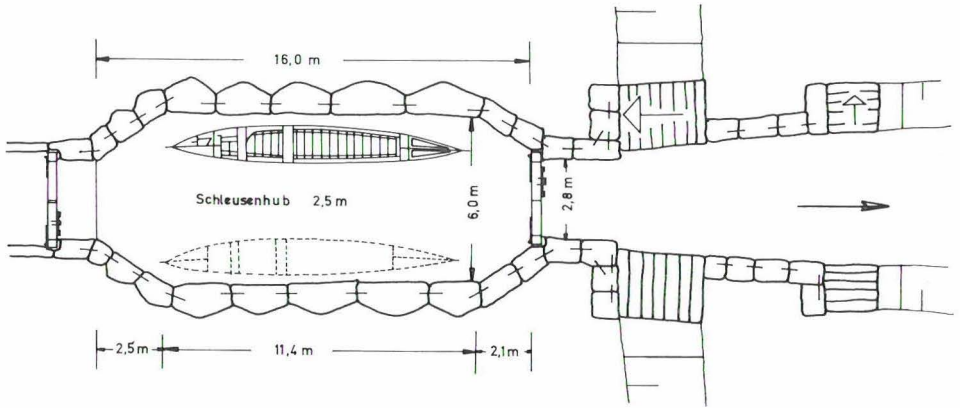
Grundriß einer Schleuse im Nymphenburger Park
